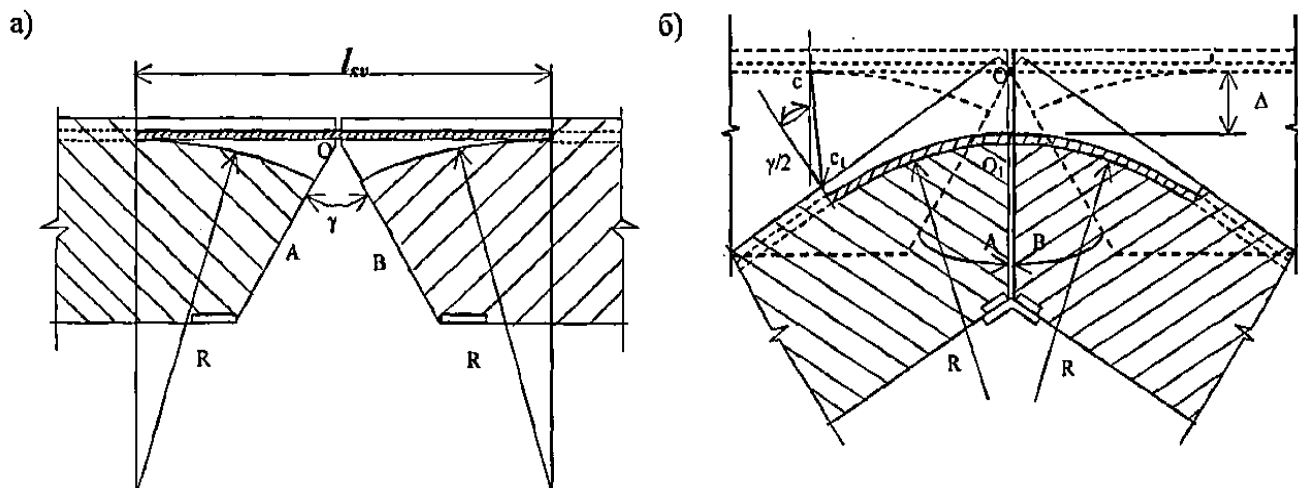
Метод виконання стикових з'єднань залізобетонних елементів
